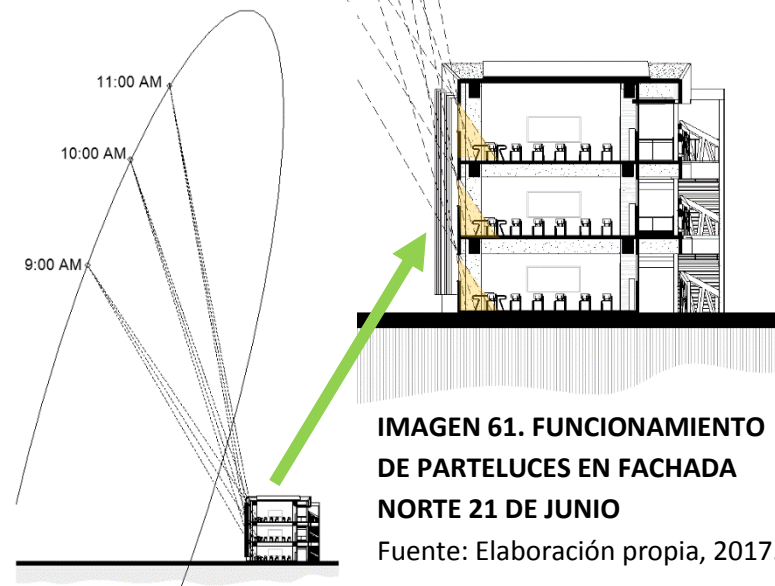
FUNCIONAMIENTO DE PARTELUCE EN FACHADA NORTE 21 DE JUNIO
